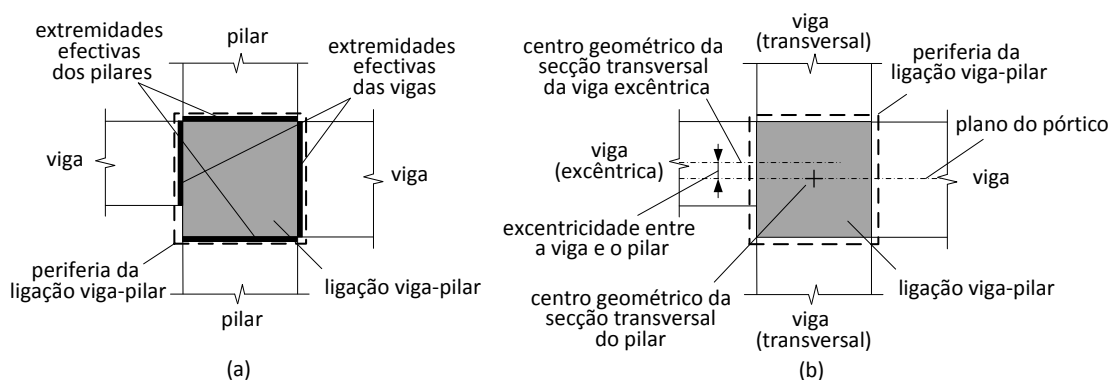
Terminologia básica: (a) vista lateral de uma ligação viga-pilar com vigas de secção transversal de diferentes alturas e (b) vista em planta de uma ligação viga-pilar excêntrica.
